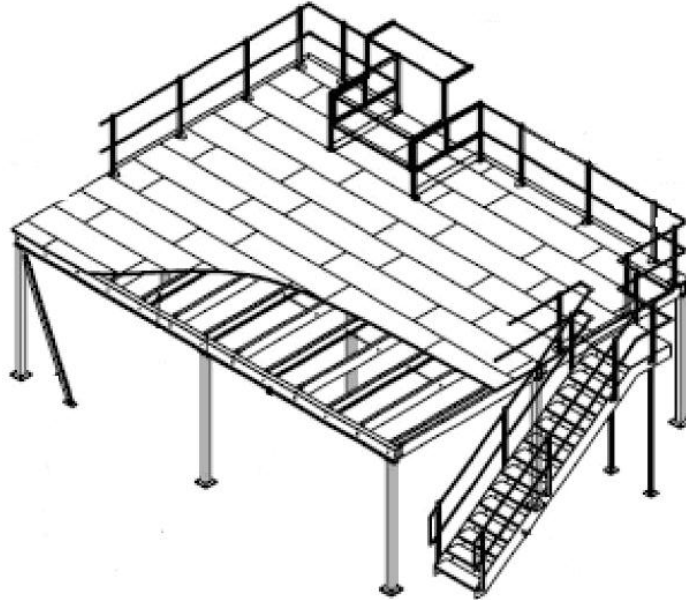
ESQUEMA ENTREPLANTA SOBRE PILARES SEGÚN UNE EN 15878
